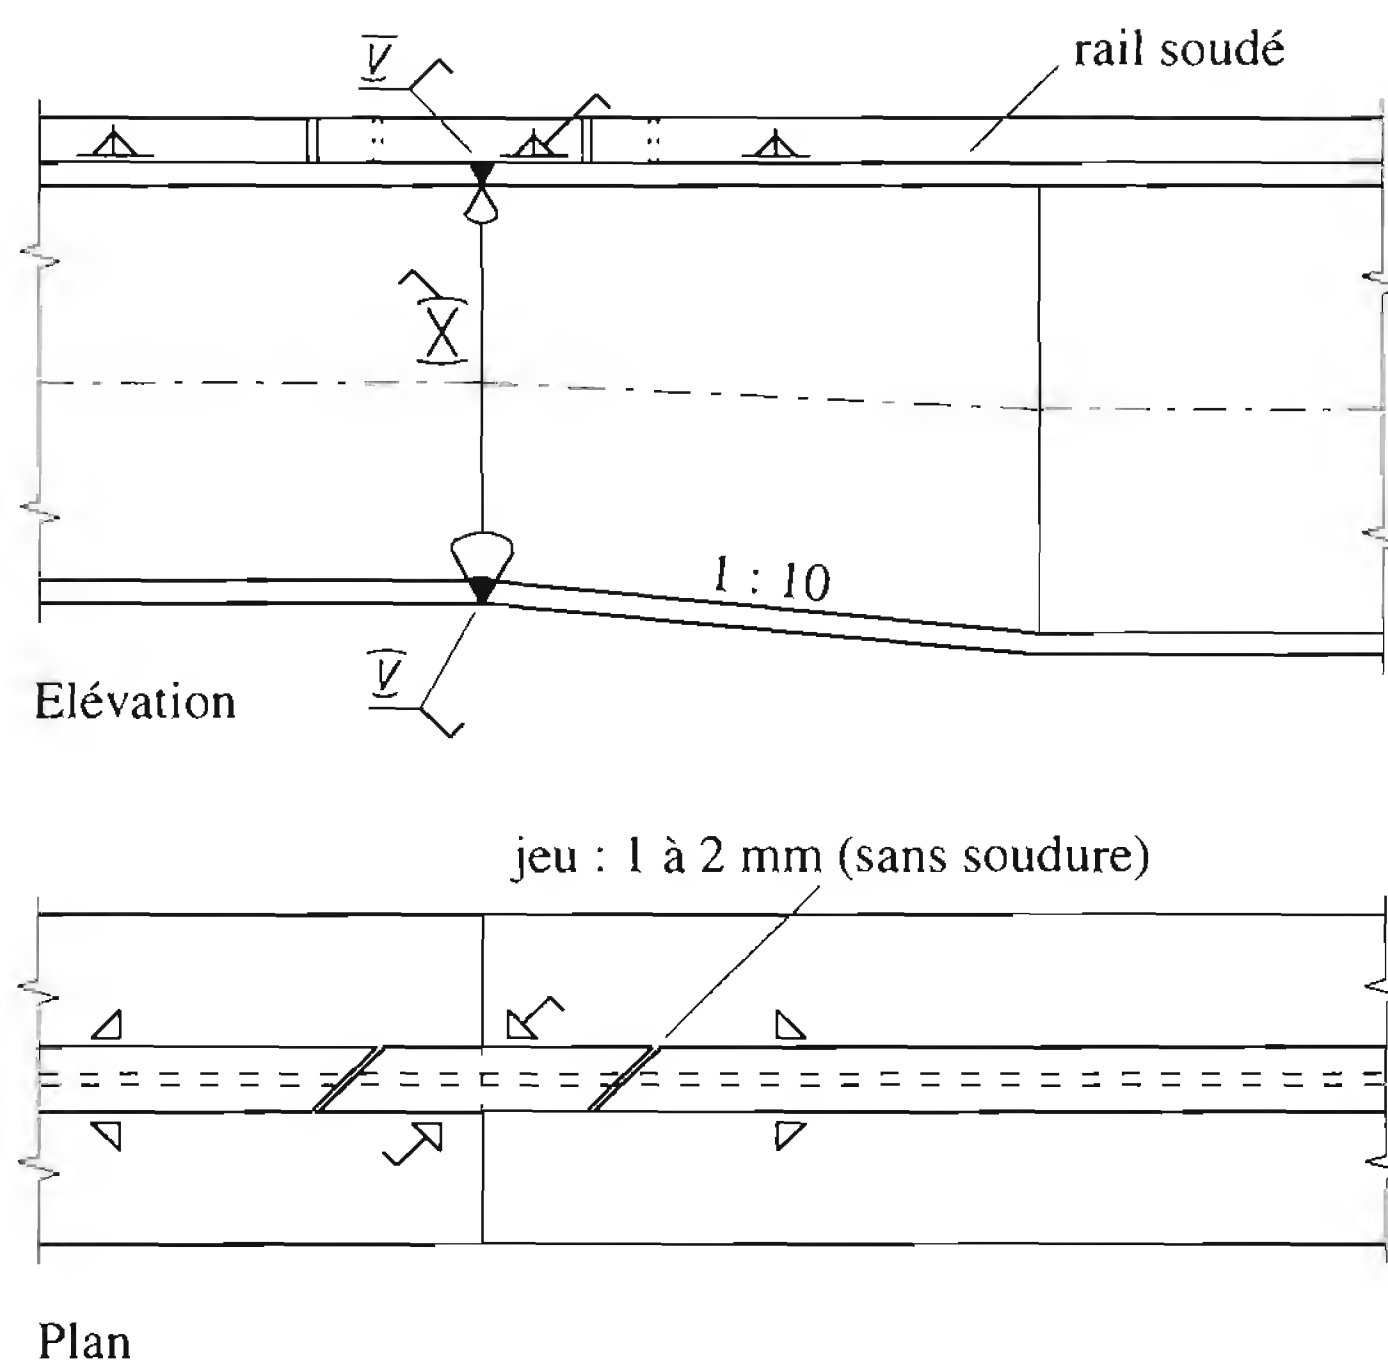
Joint de montage d'une poutre de roulement à rail soudé avec changement de section.
